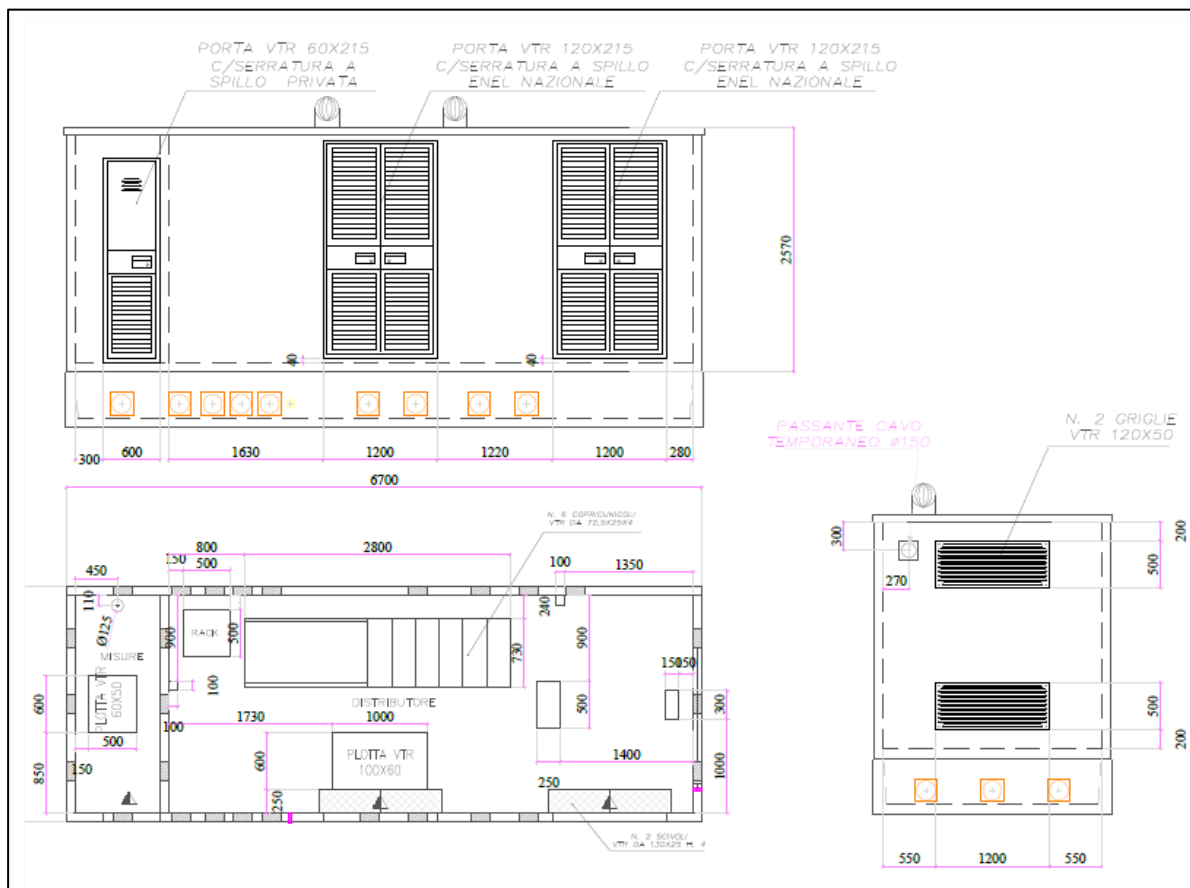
Cabina elettrica di consegna – Pianta e prospetto (GAV20\_021800\_IMP\_D\_Architettura\_Locali\_e\_Cabine\_elettriche)
